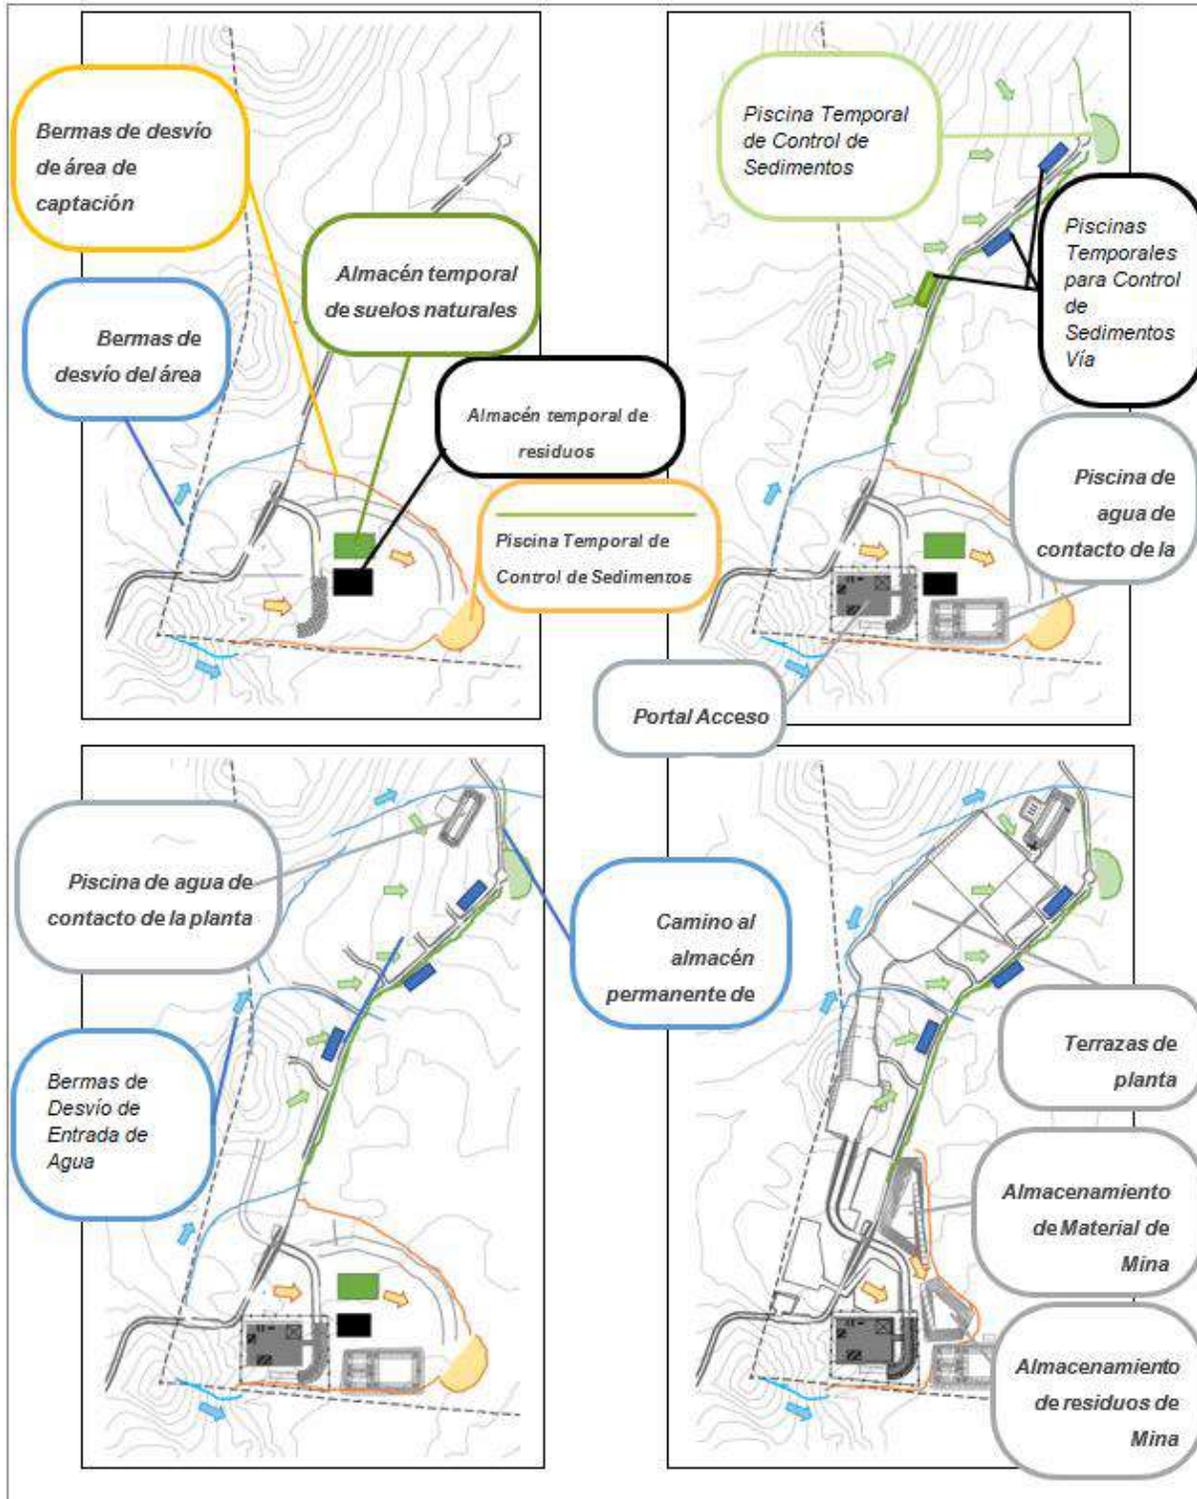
Secuencia de Construcción de la Mina y la Planta de Procesamiento de Mineral
